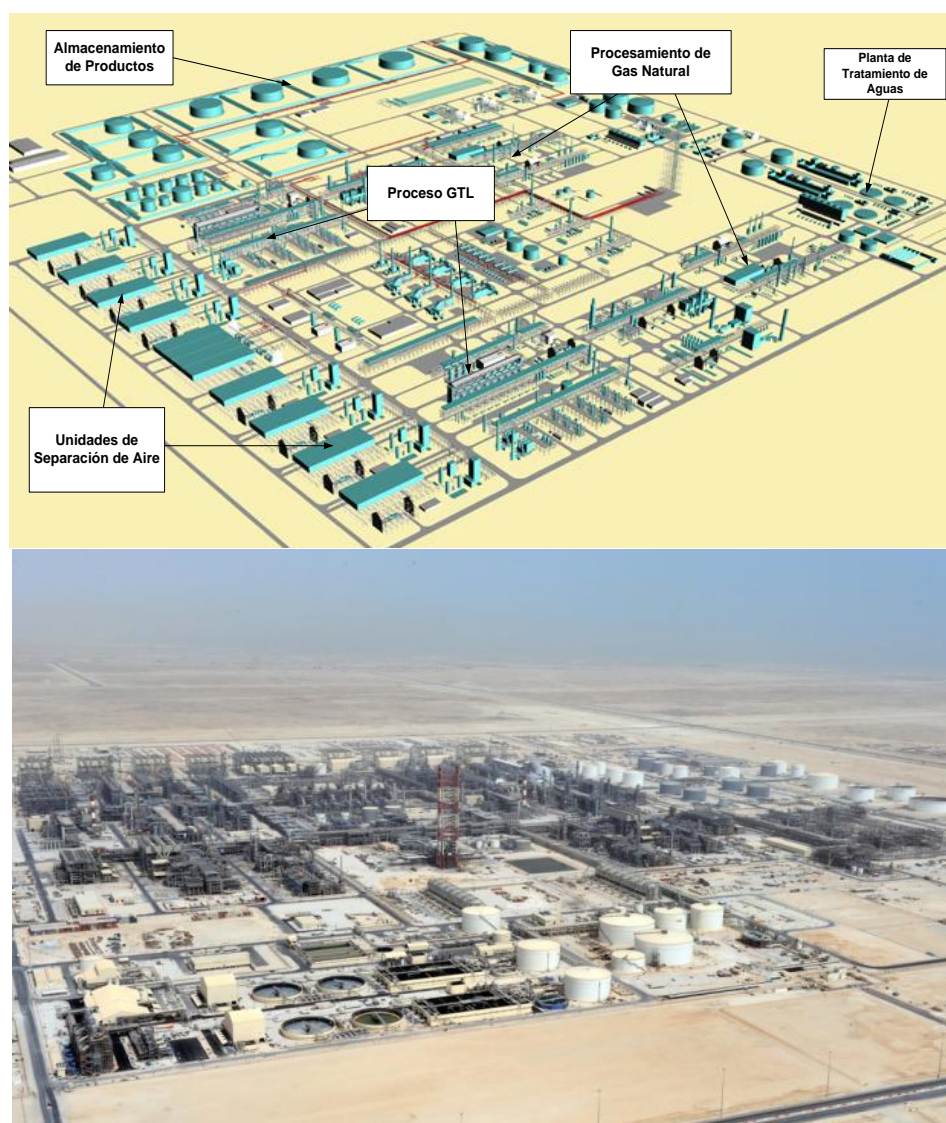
Vista de la Distribución de las Instalaciones de la Planta Pearl GTL.
